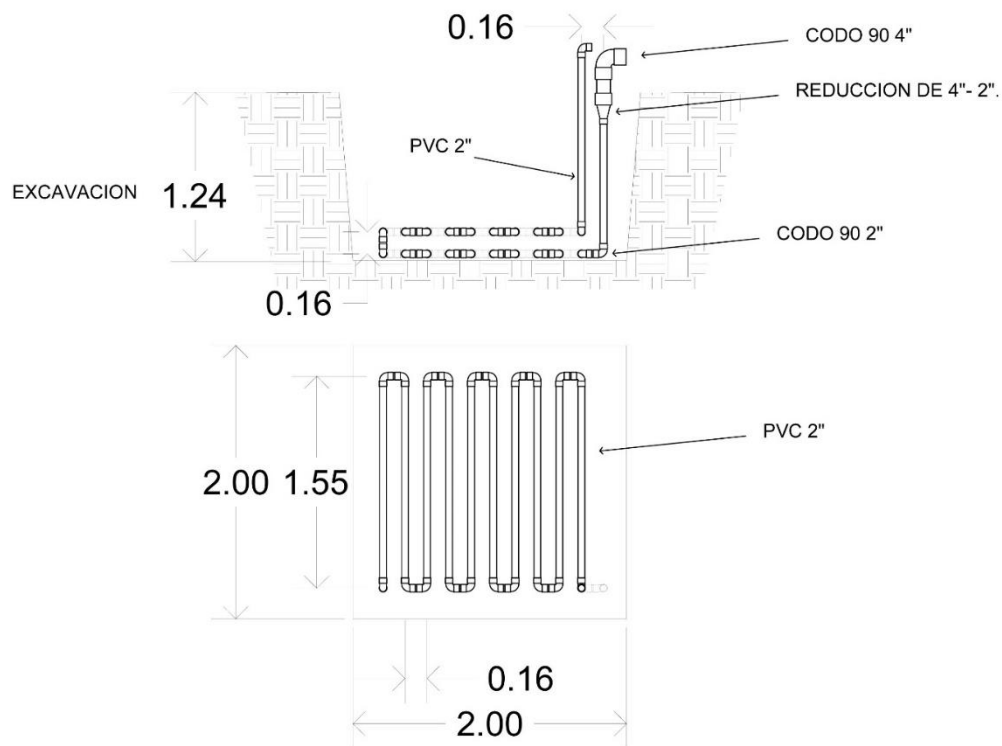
Ductos en planta y corte con profundidad de 1.24 m, longitud total de 34.2 m
